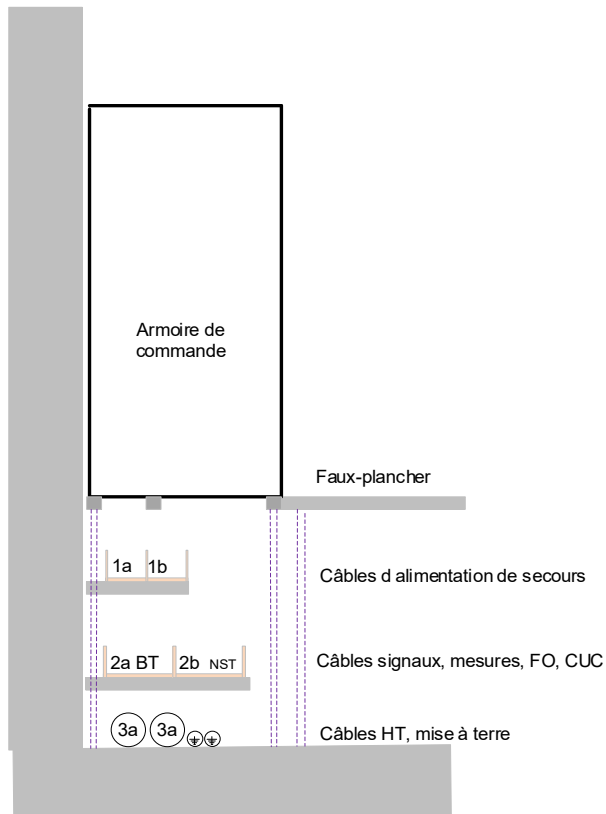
Exemple de disposition des câbles dans un faux-plancher
